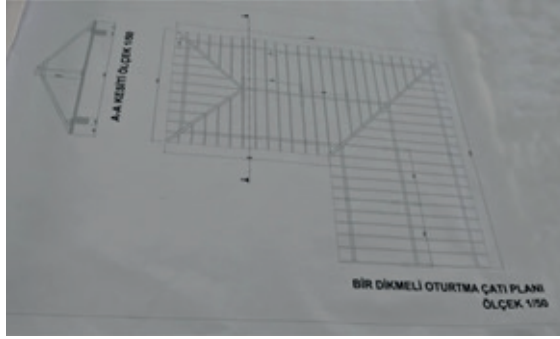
Bir dikmeli oturtma çatı planı ve kesiti
